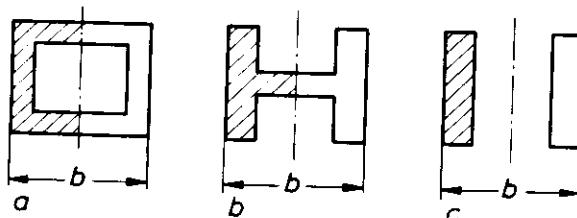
Druckzonen bei aufgelösten Grundrißformen von Flächenfundamenten
